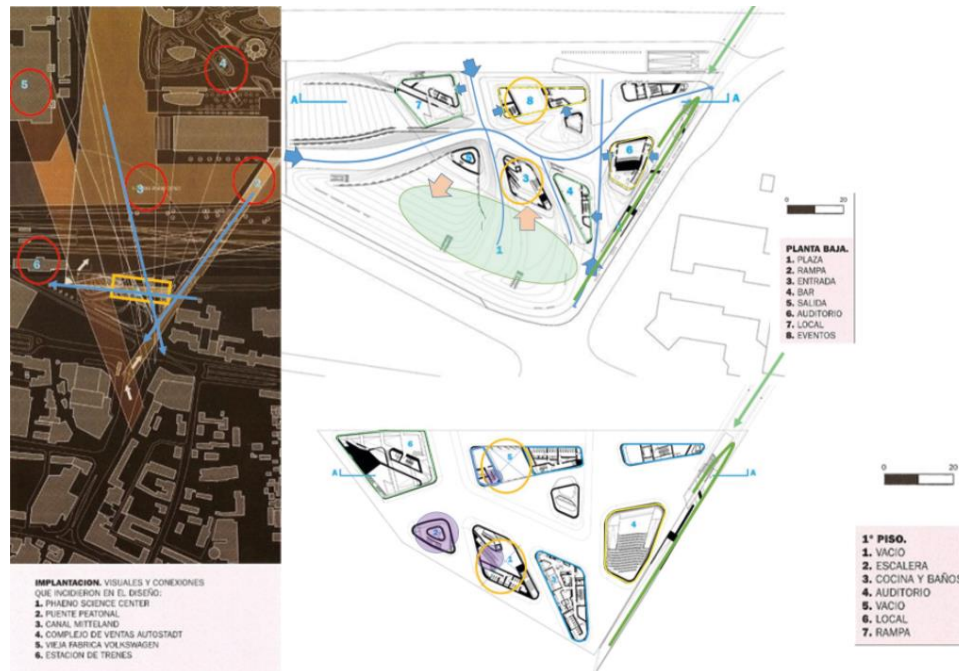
Plantas y ubicación Phaeno -Zaha Hadid.
